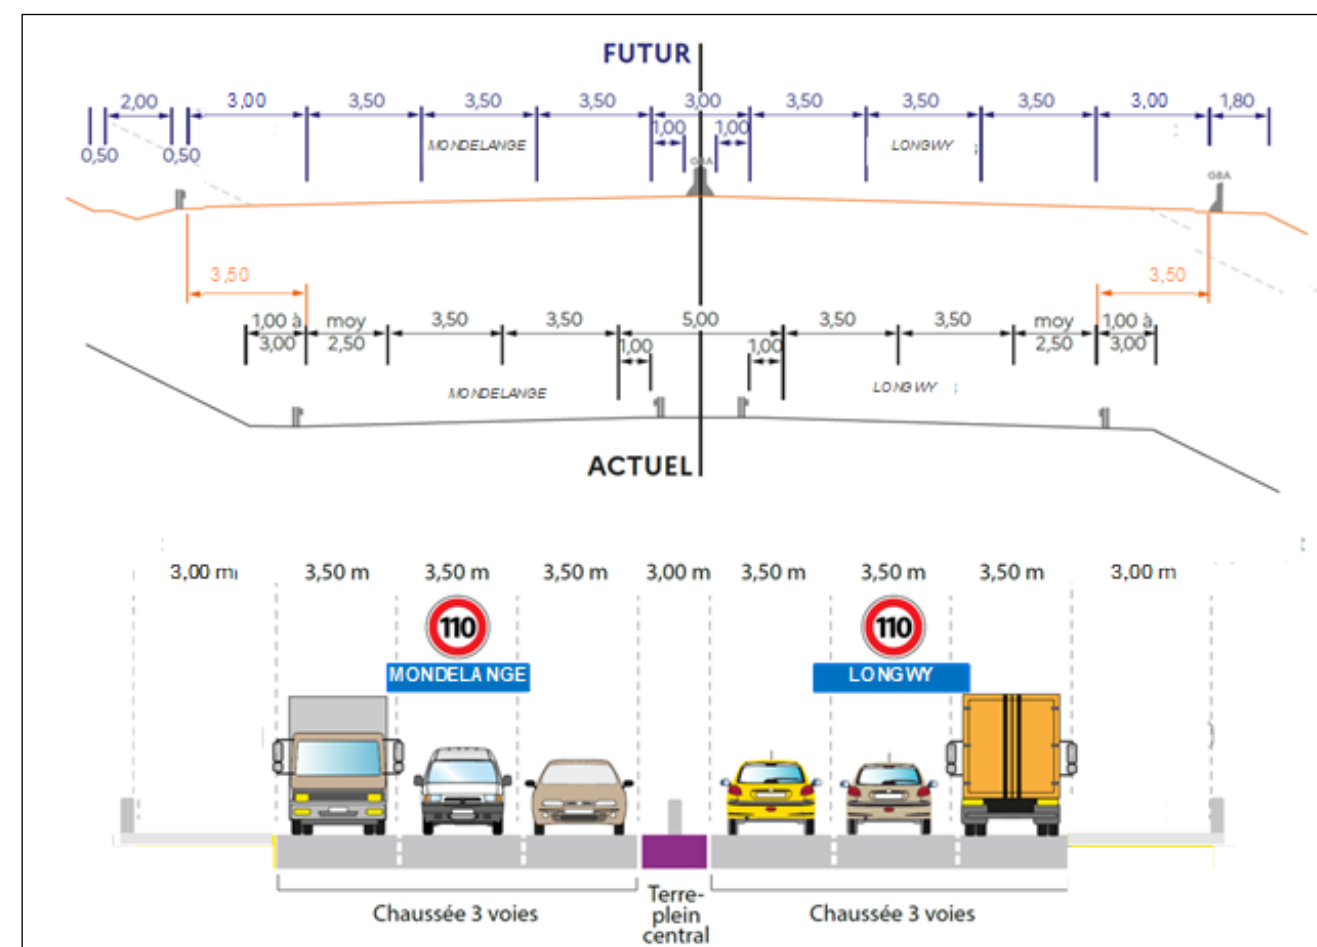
Profil en travers schématique de l'élargissement de l'autoroute A30 entre Fameck et Richemont
